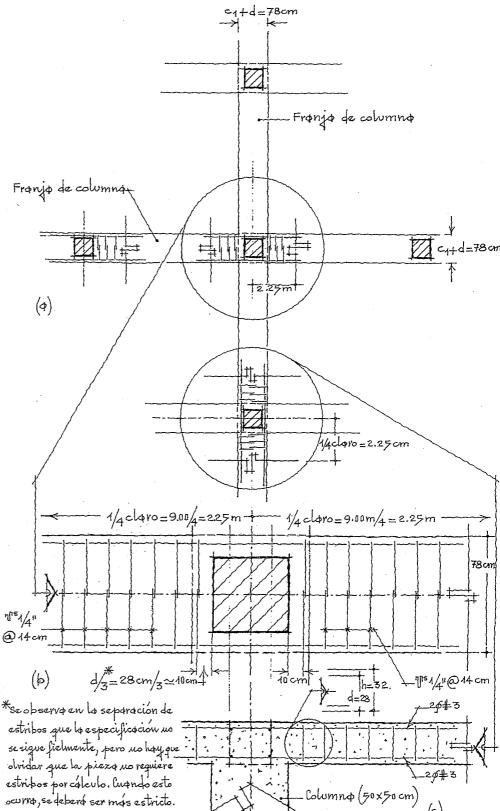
Fronjo efectwo de columna vista enplanta, (b).
